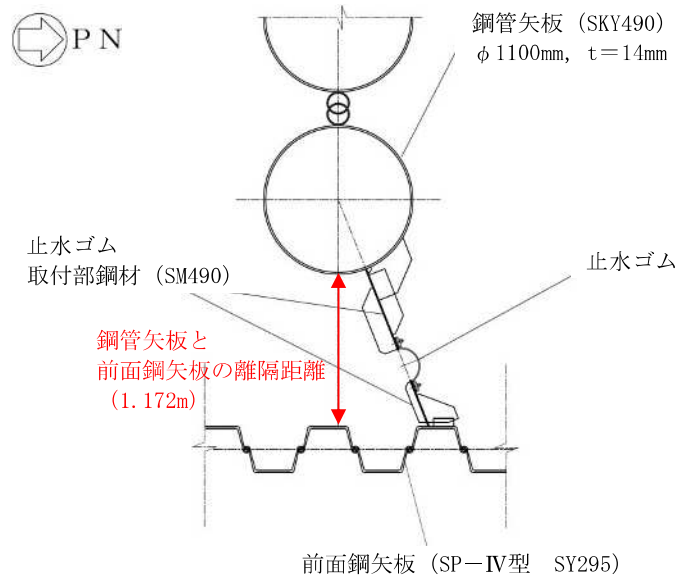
(2) 海水貯留堰の平面図 (南側接続部 止水ゴム取付部鋼材)
